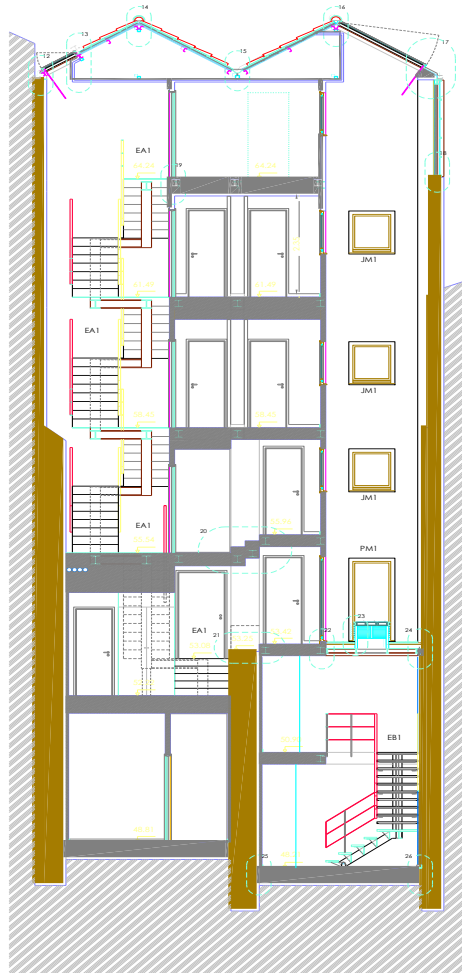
Corte longitudinal do edifício - Fonte: Projeto de arquitetura
